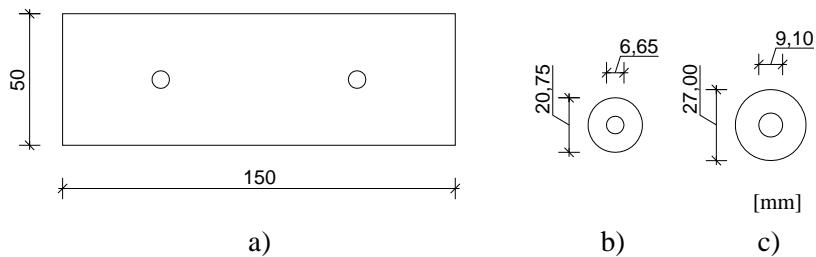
Geometria em planta das chapas de ancoragem usadas nos modelos reforçados
